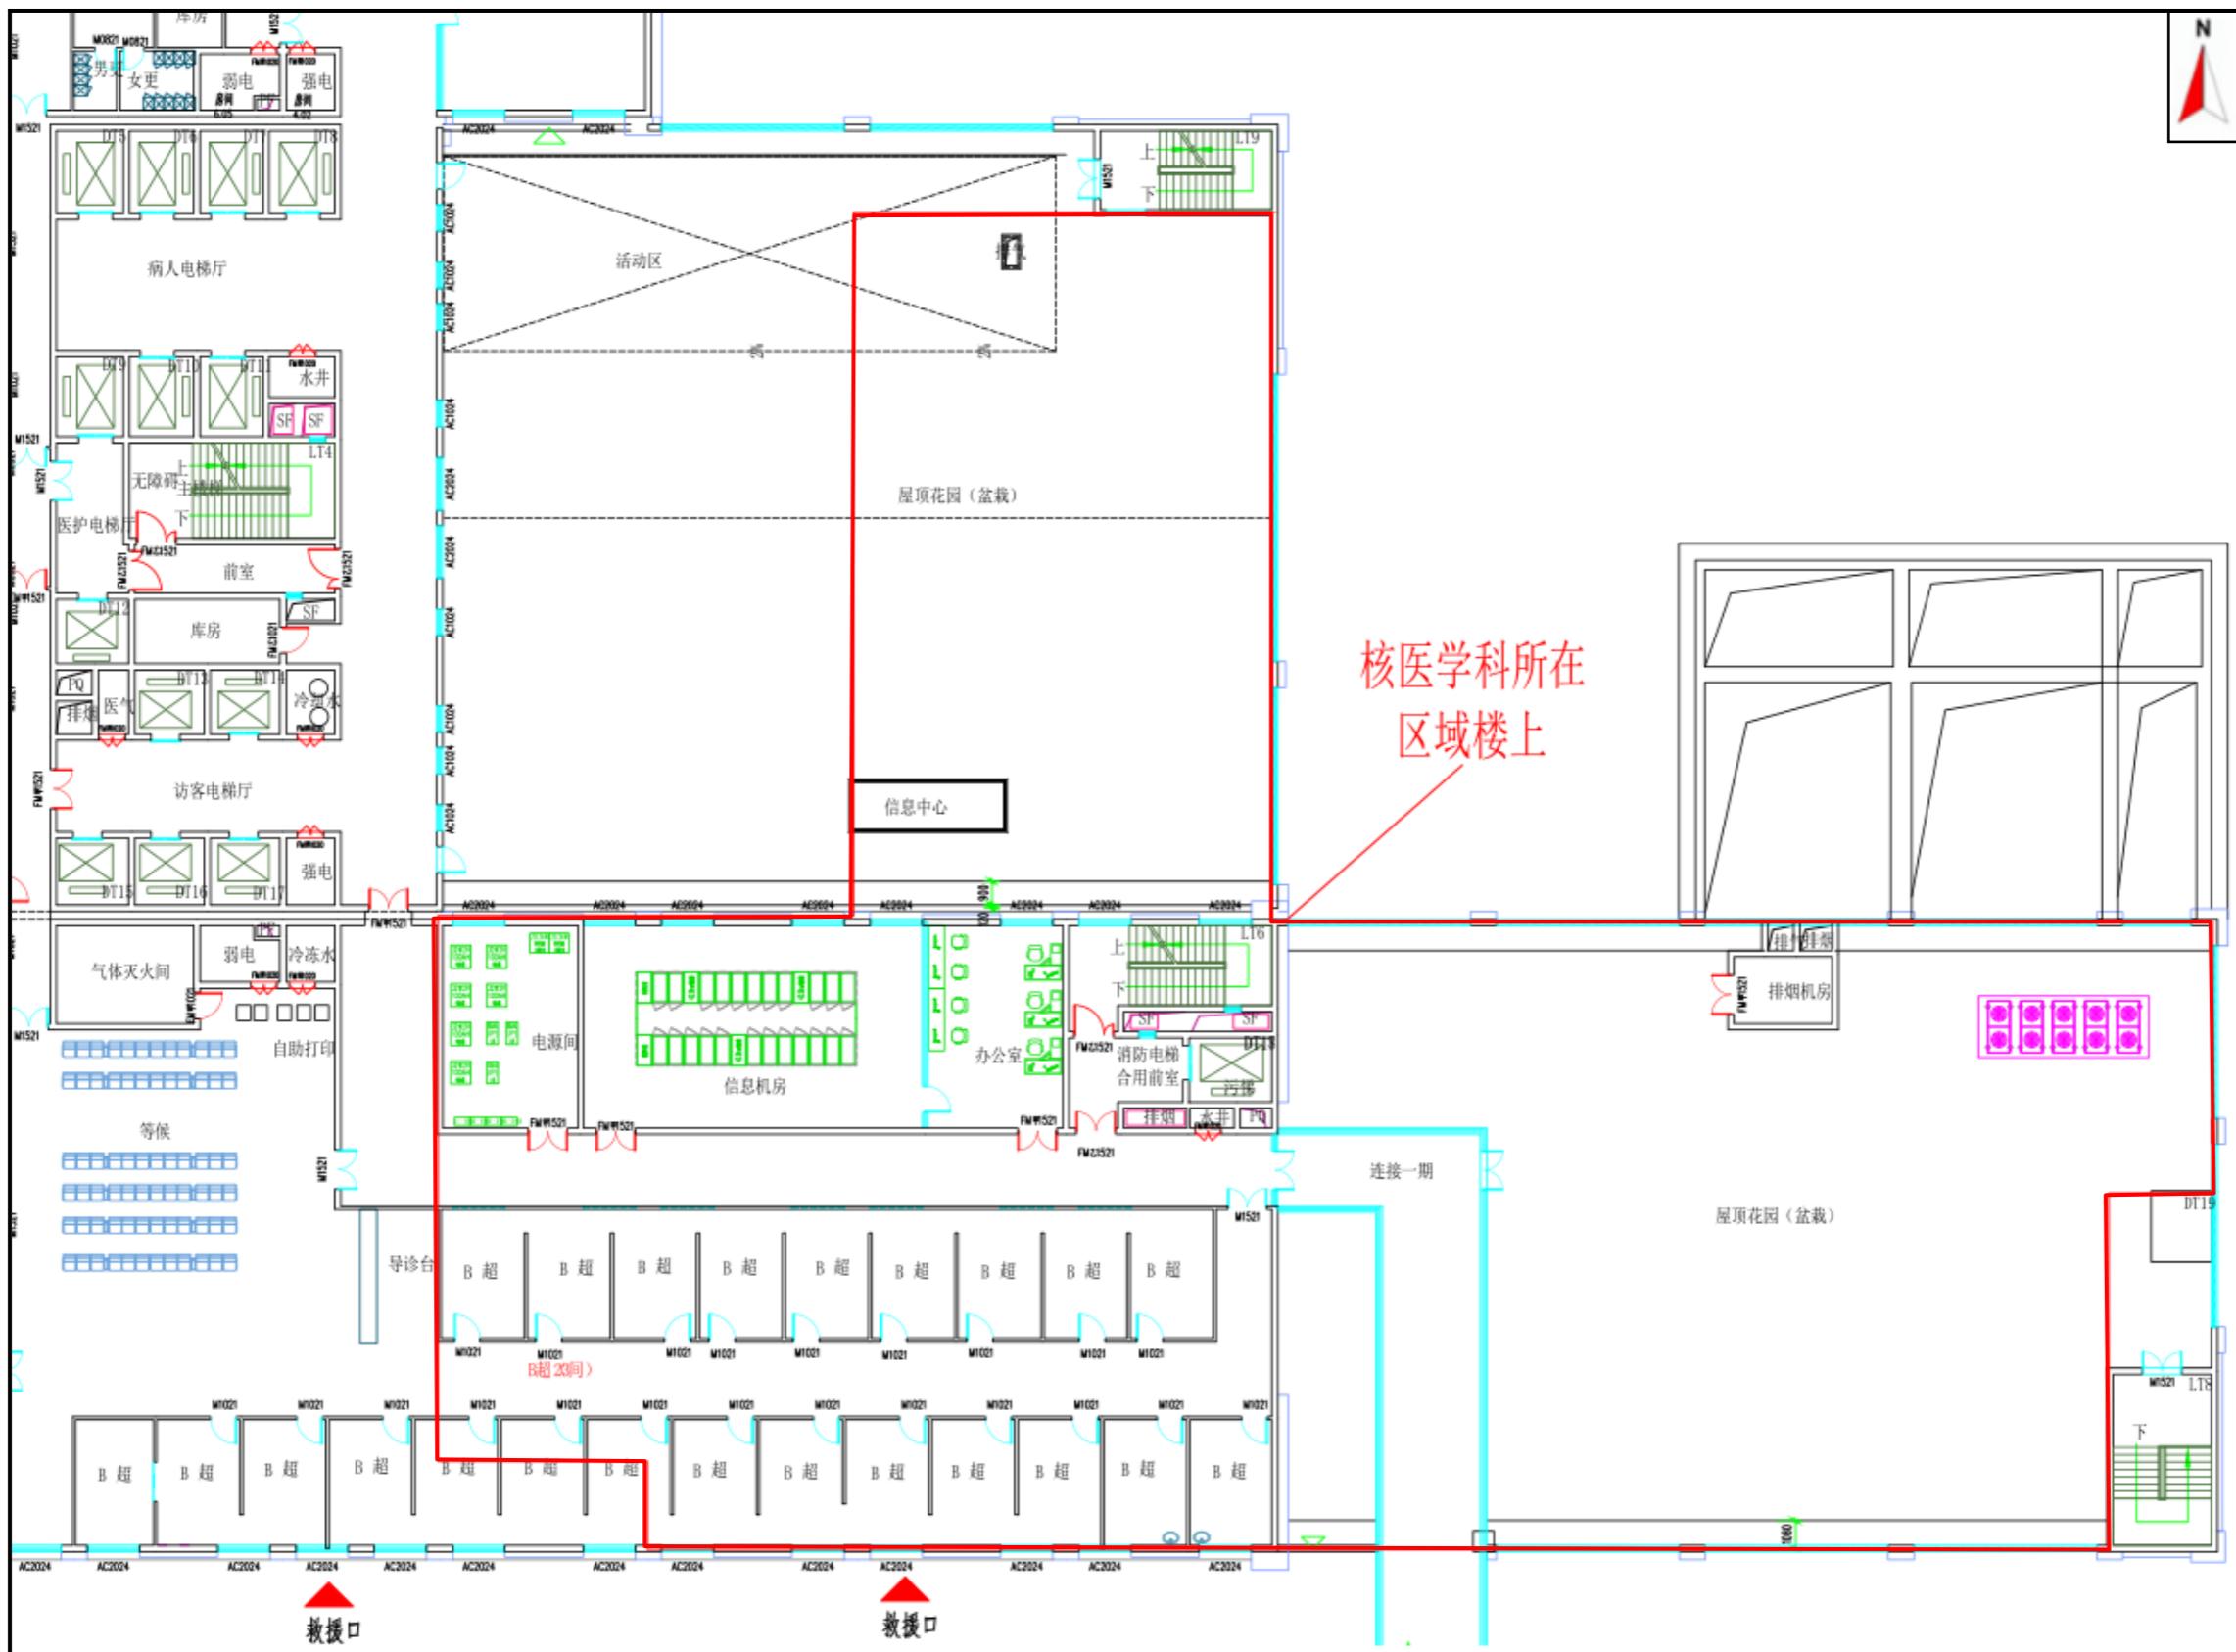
项目核医学科区域楼上平面布置图 (三楼)
